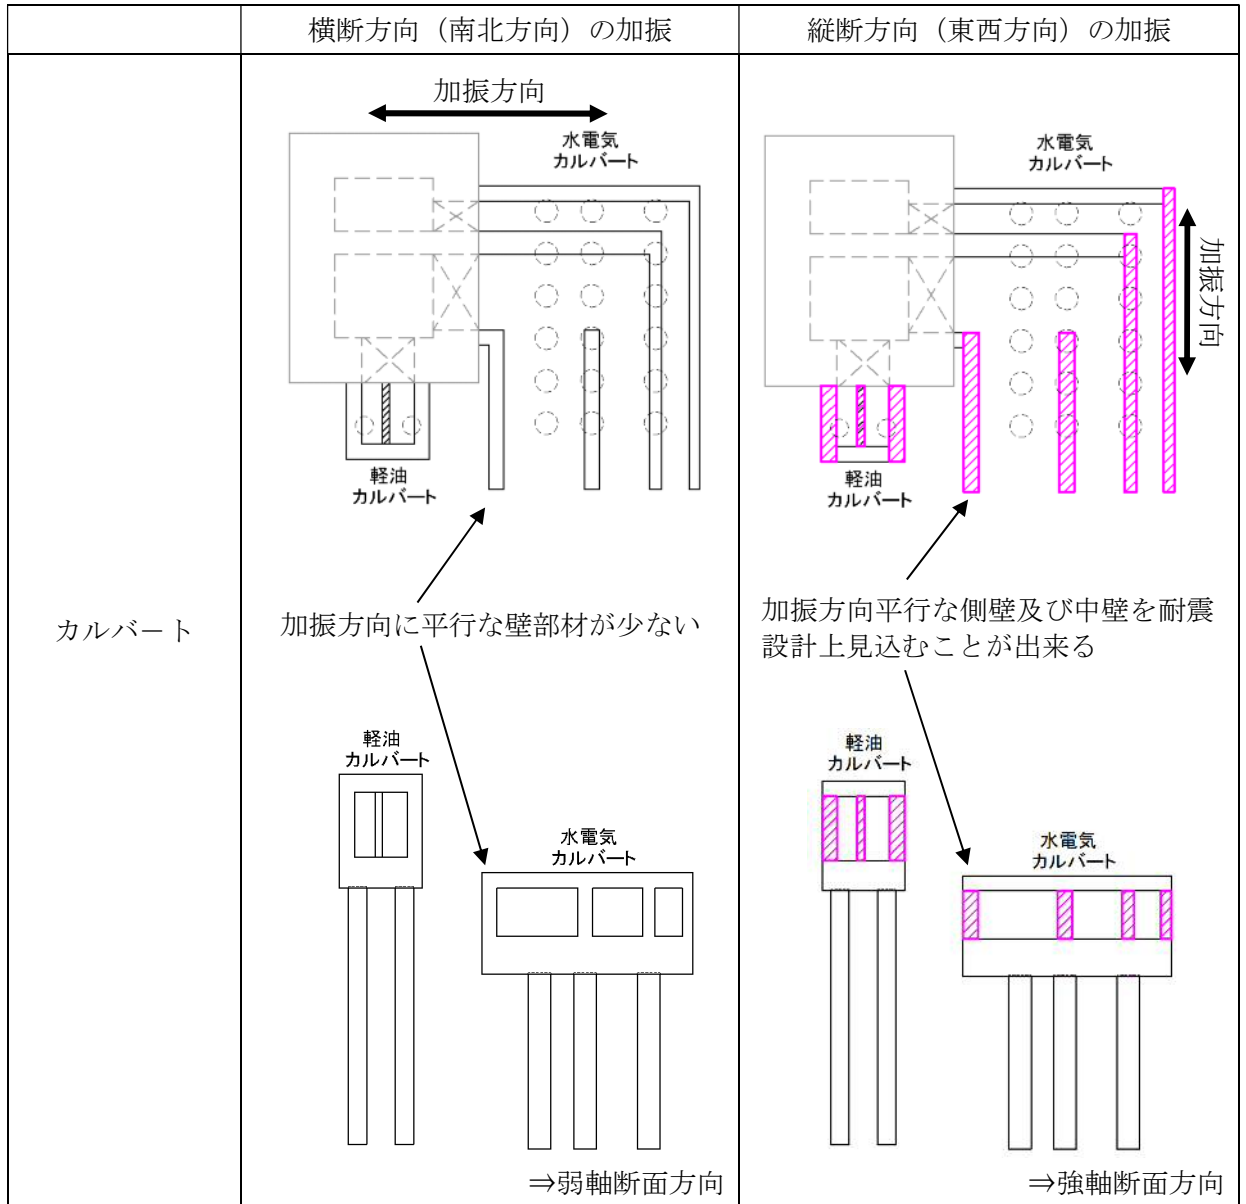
(2) カルバートの平面配置図 (拡大図)
